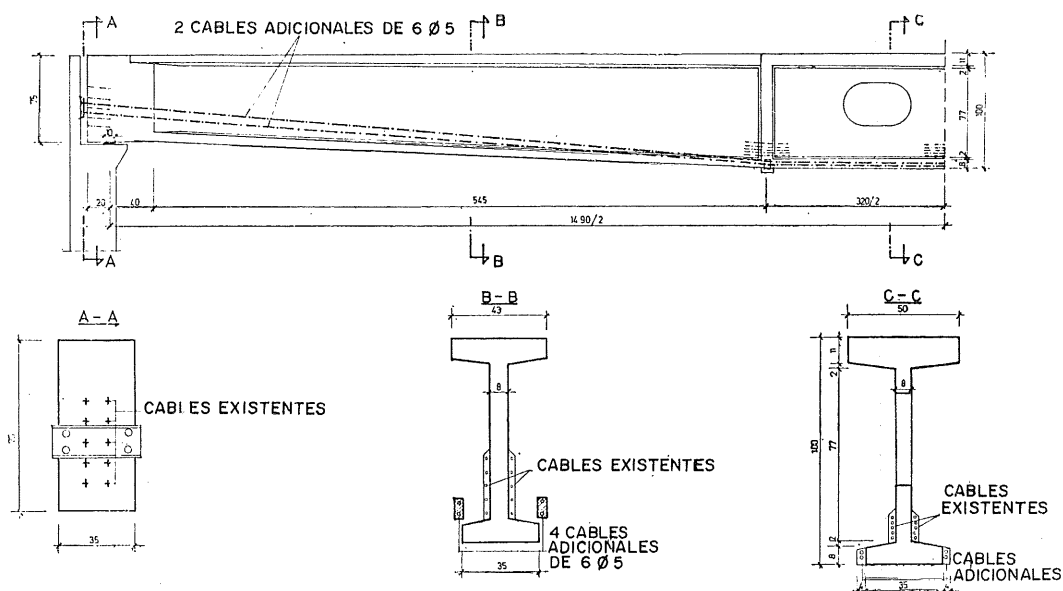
Detalles de la reparación de una viga de cubierta, de hormigón pretensado, de luz igual a 14,90 m introduciendo cuatro cables adicionales de 6 Ø 5, de acero 140/165.
